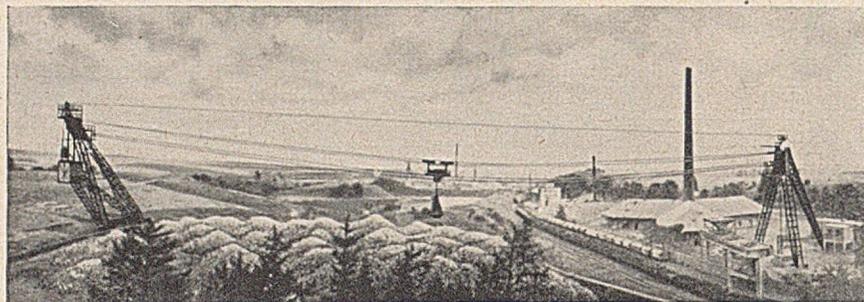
Gesamtansicht der Kabelkrananlage an der Zementfabrik Dornap mit den Werksanlagen und dem Lagerplatz zur Stapelung von Kalkstein.
